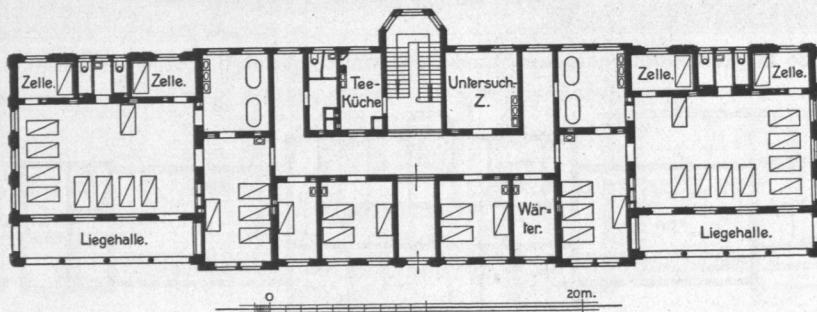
Allgemeines Krankenhaus Hamburg-Barmbeck, Pavillon für nervöse und psychose Kranke, Erdgeschoß, Grundriß.
